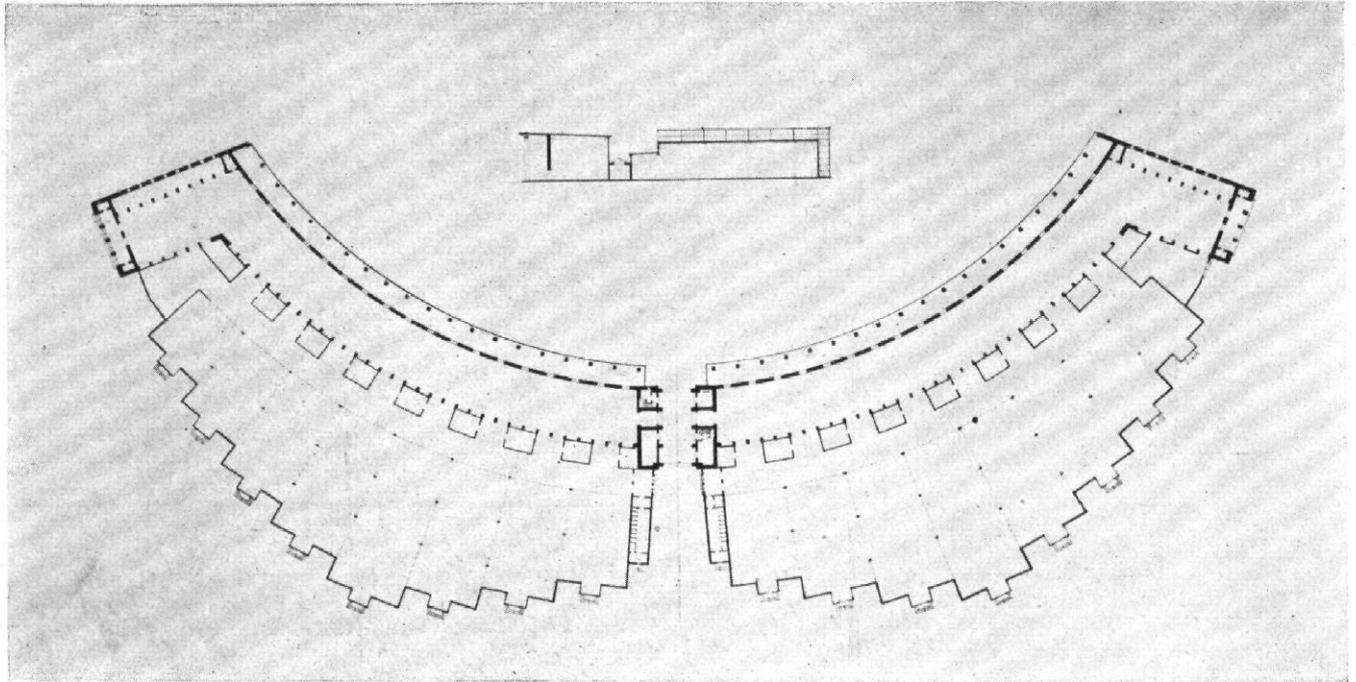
/ Presse-Ausstellung „Pressa“ in Köln / Staatenhaus-Grundriß 1:1600 (vgl. 9 bis 13)
